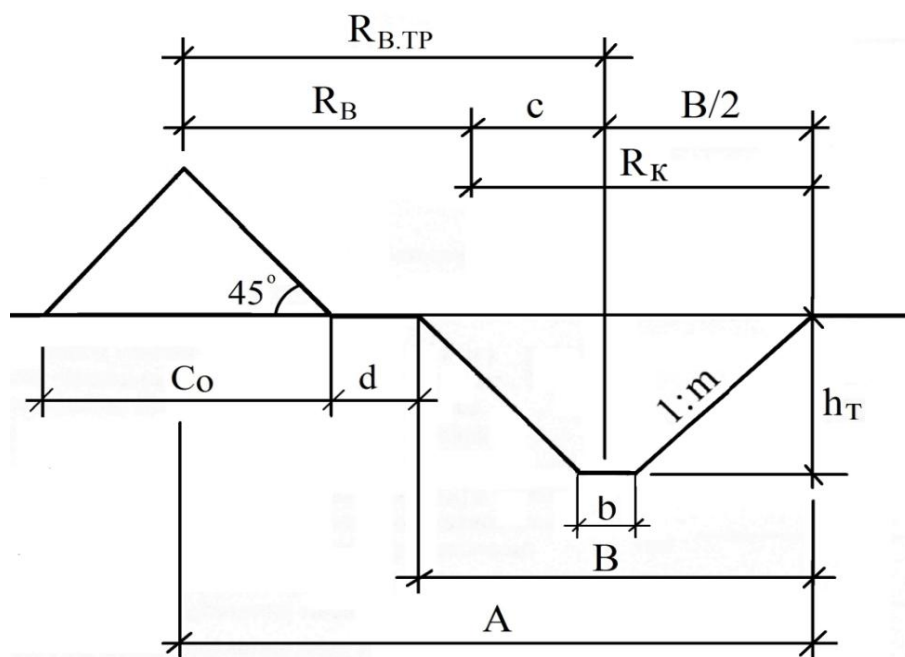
Расчетная схема для определения технических параметров экскаватора при движении его параллельно оси траншеи со смещением в сторону отвала грунта (боковая проходка)
